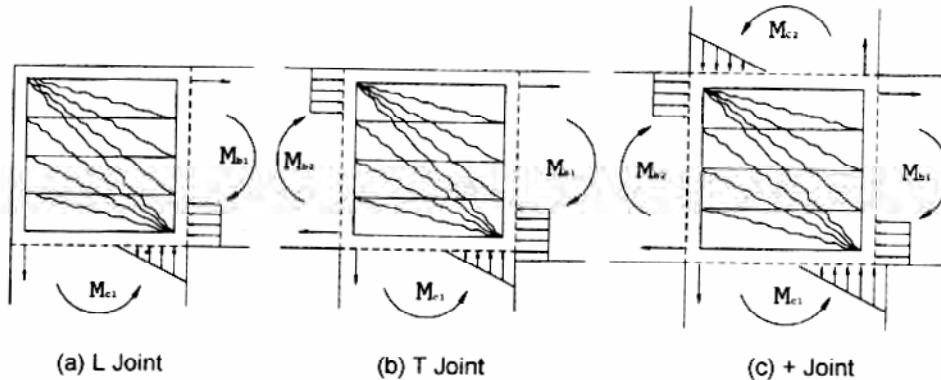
Modes de fissuration nœud poteau-poutre
